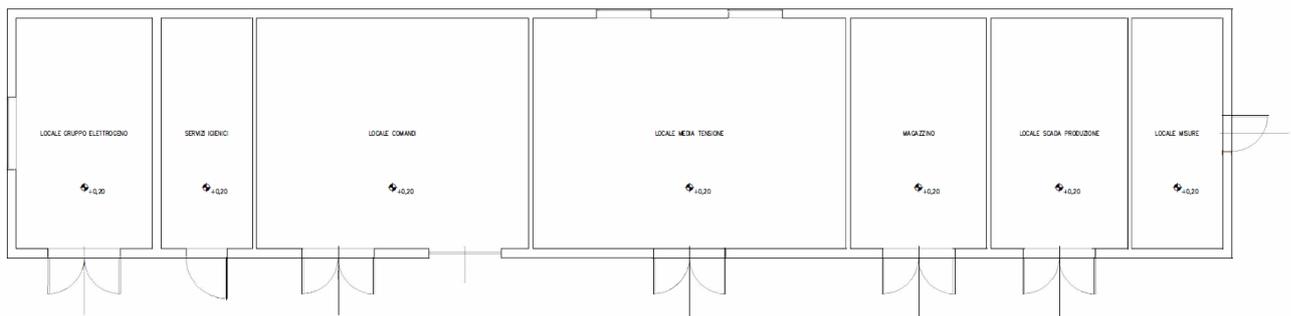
Architettura fabbricato Cabina Utente 150/30 kV – Pianta
